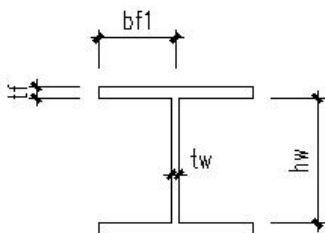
预制劲性柱中焊接 H 型钢示意图
